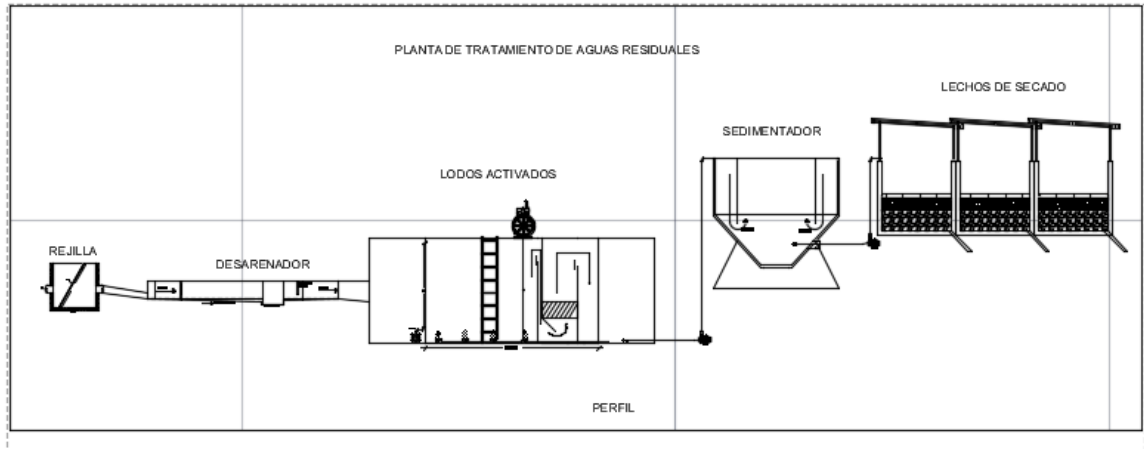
Planta de tratamiento de aguas residuales en planta
